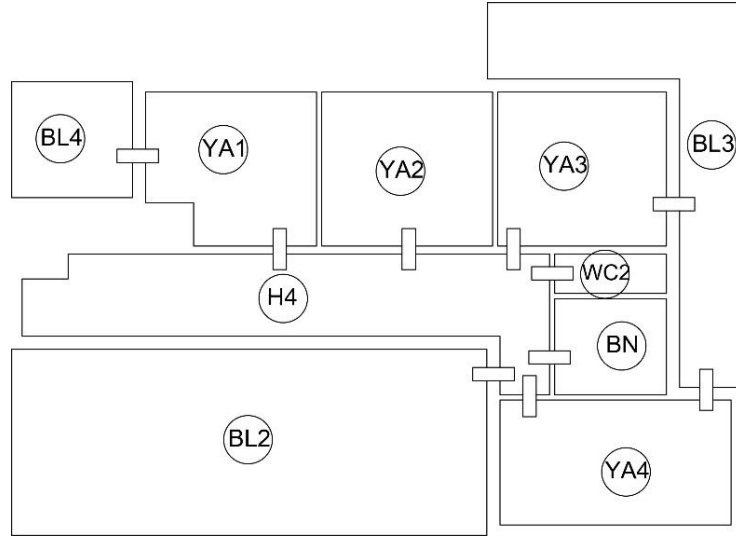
Göztepe'de Konut Projesi giriş kat planı
